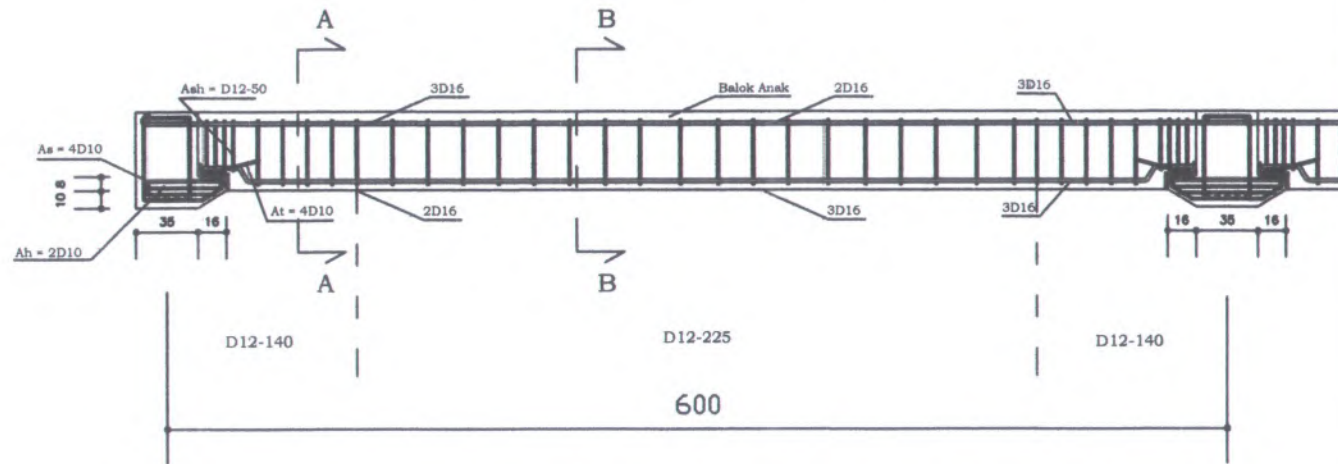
DETAIL SAMBUNGAN BALOK INDUK DAN KOLOM
